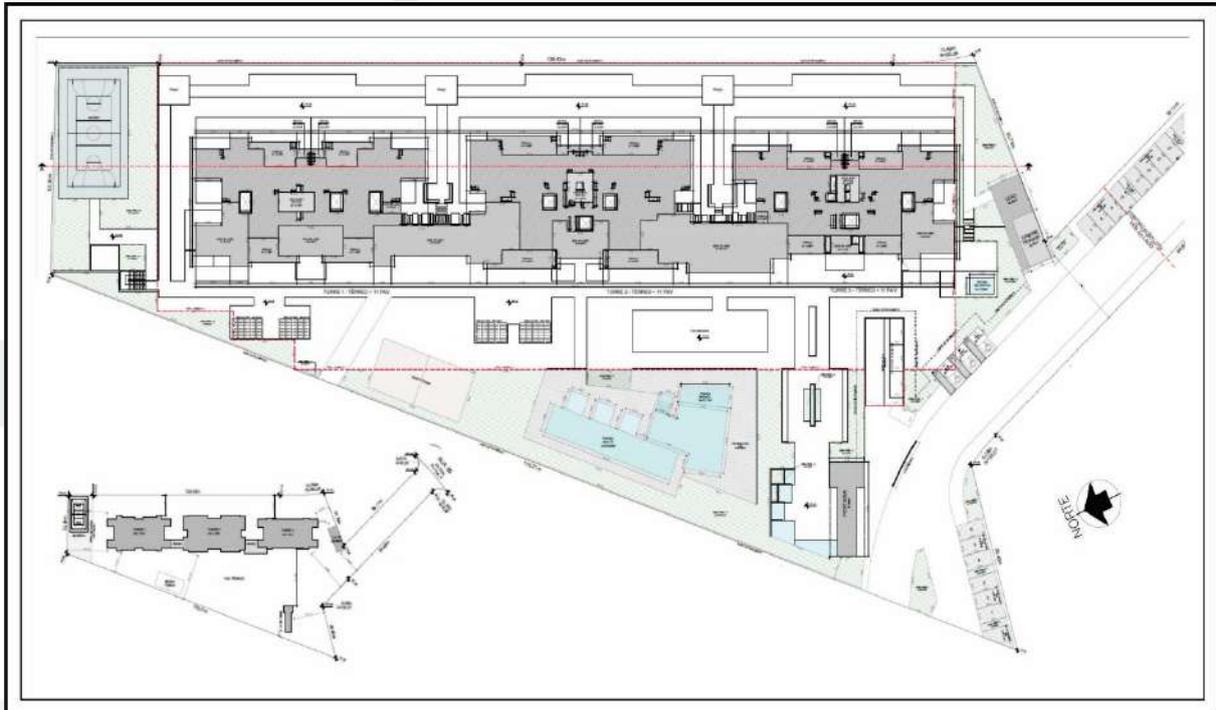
Projeto Arquitetônico pretendido – Lote 1A – Fase 1
